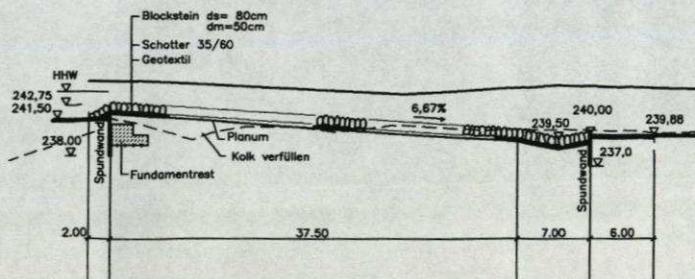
Längsschnitt der geplanten Blocksteinrampe
